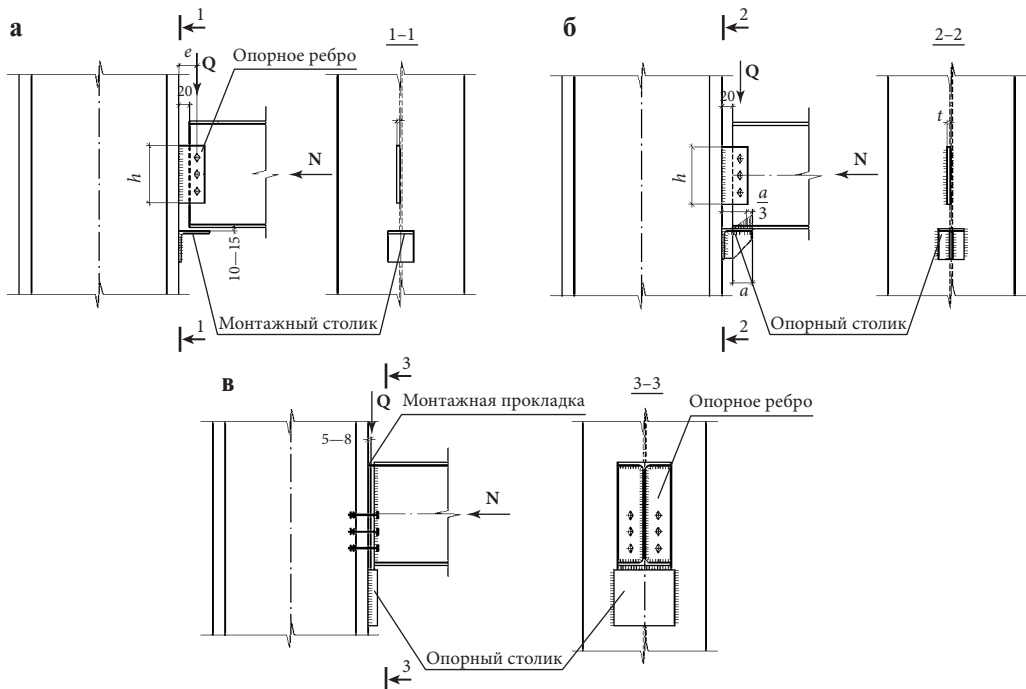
Шарнирное крепление балок к колоннам: а) крепление балки к колонне при помощи опорного ребра; б) крепление балки к колонне при помощи опорного ребра и опорного столика; в) крепление балки к колонне при помощи опорного столика
